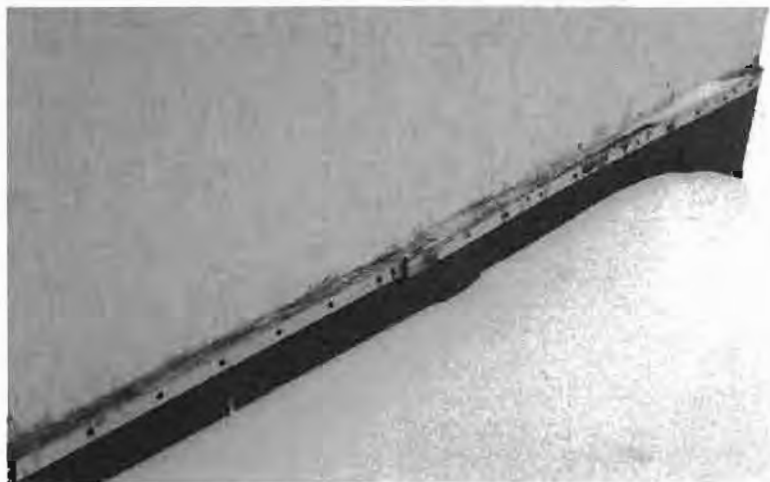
Фрагмент примыкания гидроизоляционного ковра к стенке в осях Гс/2с-3с (по проекту шифр 07.001.74/14-04Б-АРЗ, 3 секция, лист 5). Отслоение прижимного листа, разрушение герметика. Следы грязи и пыли на герметике и под прижимной металлической планкой. Трещины по поверхности герметика.
